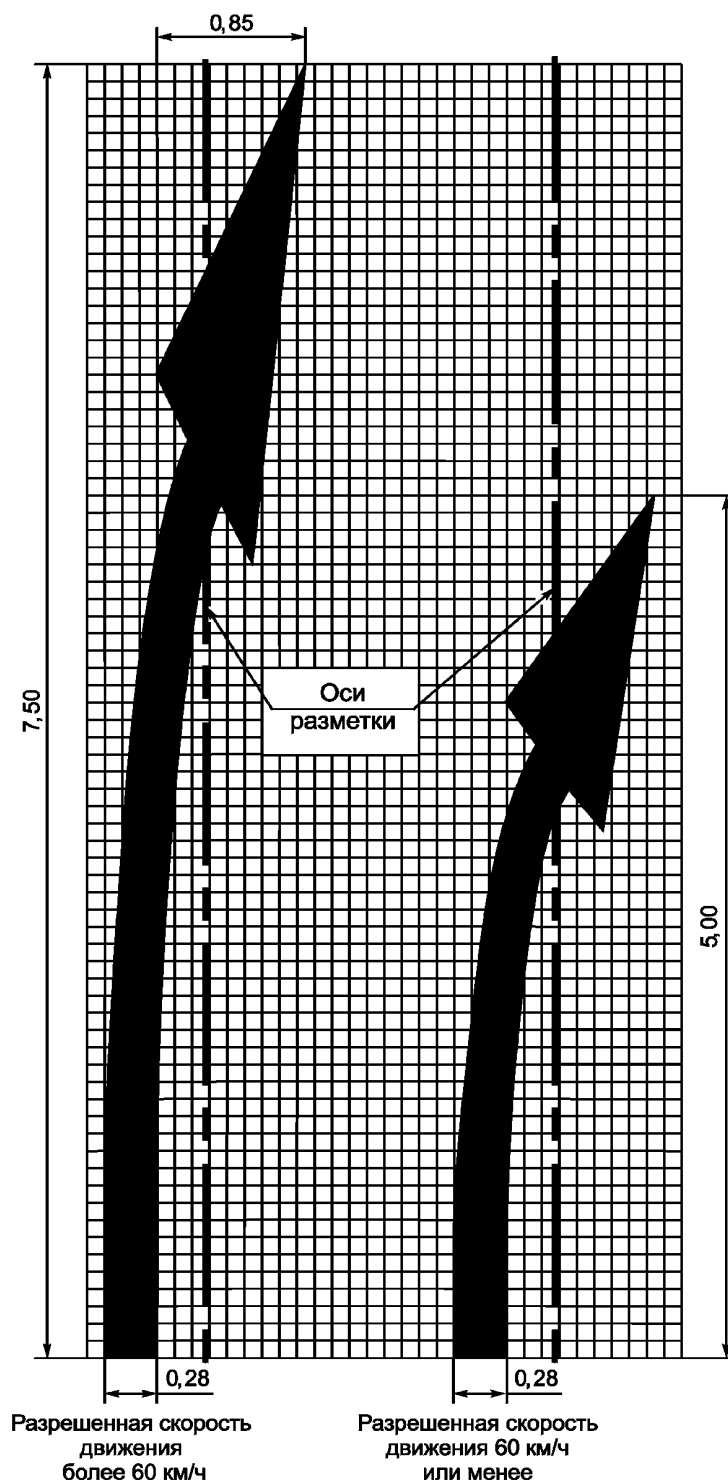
Расположение и размеры стрел разметки типа 1.19
